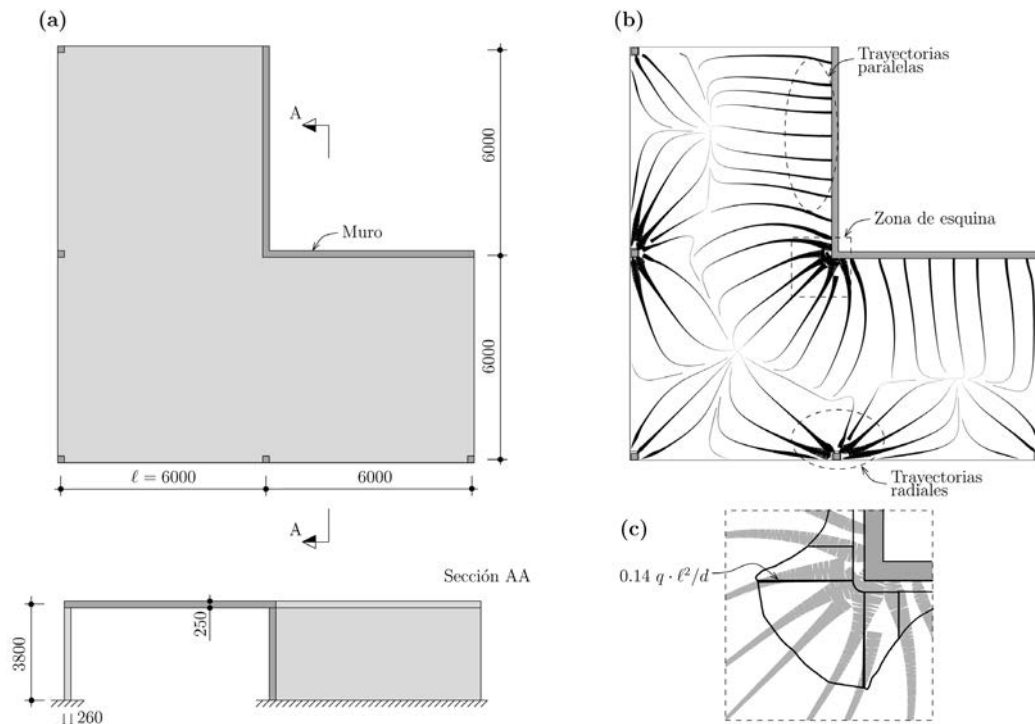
Campo de esfuerzos cortantes en una losa delgada apoyada sobre cinco pilares y un muro en forma de "LÓ (a) geometría de la losa (cotas en [mm]); (b) campo de esfuerzos cortantes y regiones; y (c) detalle del reparto de esfuerzos cortantes en la región de la esquina.
